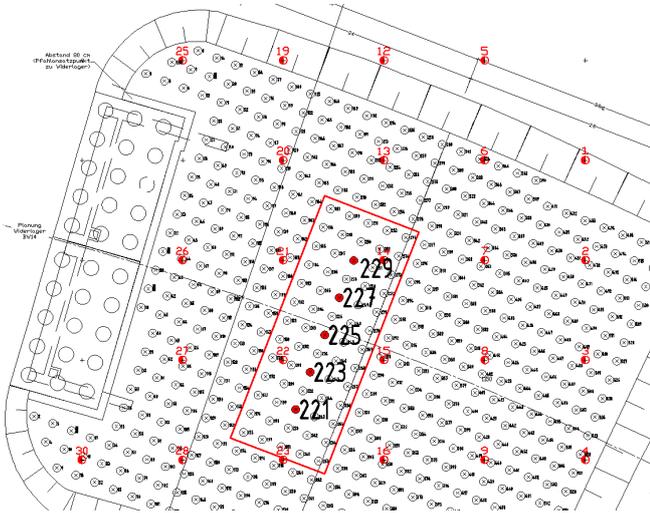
Auszug Plan „Anschluss Widerlager“: Verteilung Fertigrampfpfähle mit Darstellung des Probefeldes, 5 Prüfpfählen und Drucksondierpunkten.
